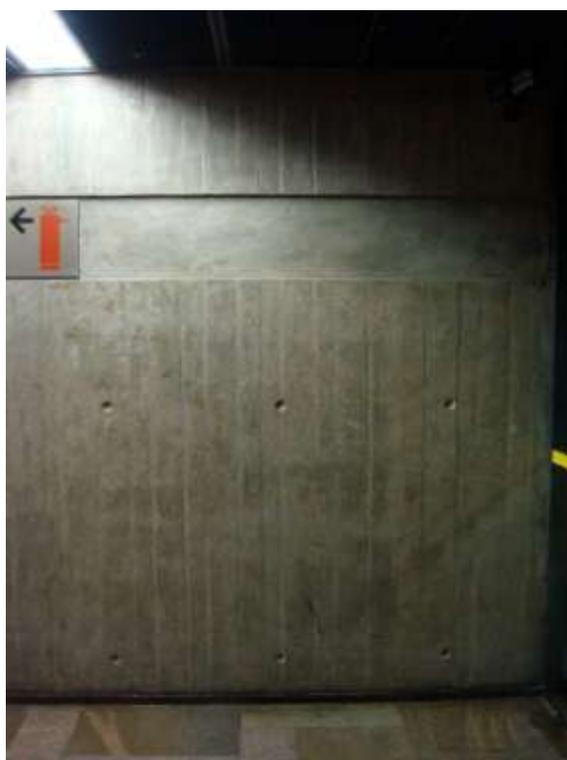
Vista da parede de concreto contrastando com o piso de pedra, ambos obedecem ao traçado regulador. Foto: CANTALICE II.
